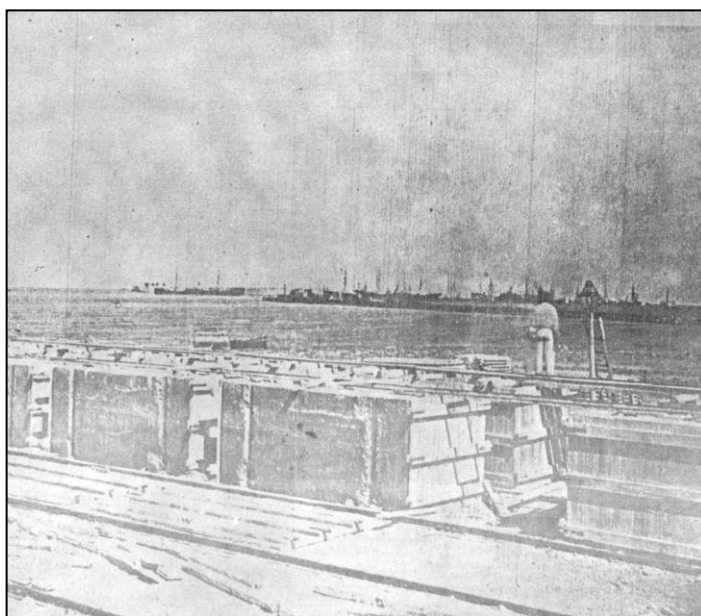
Bloques de concreto de 30 ton.¹¹
